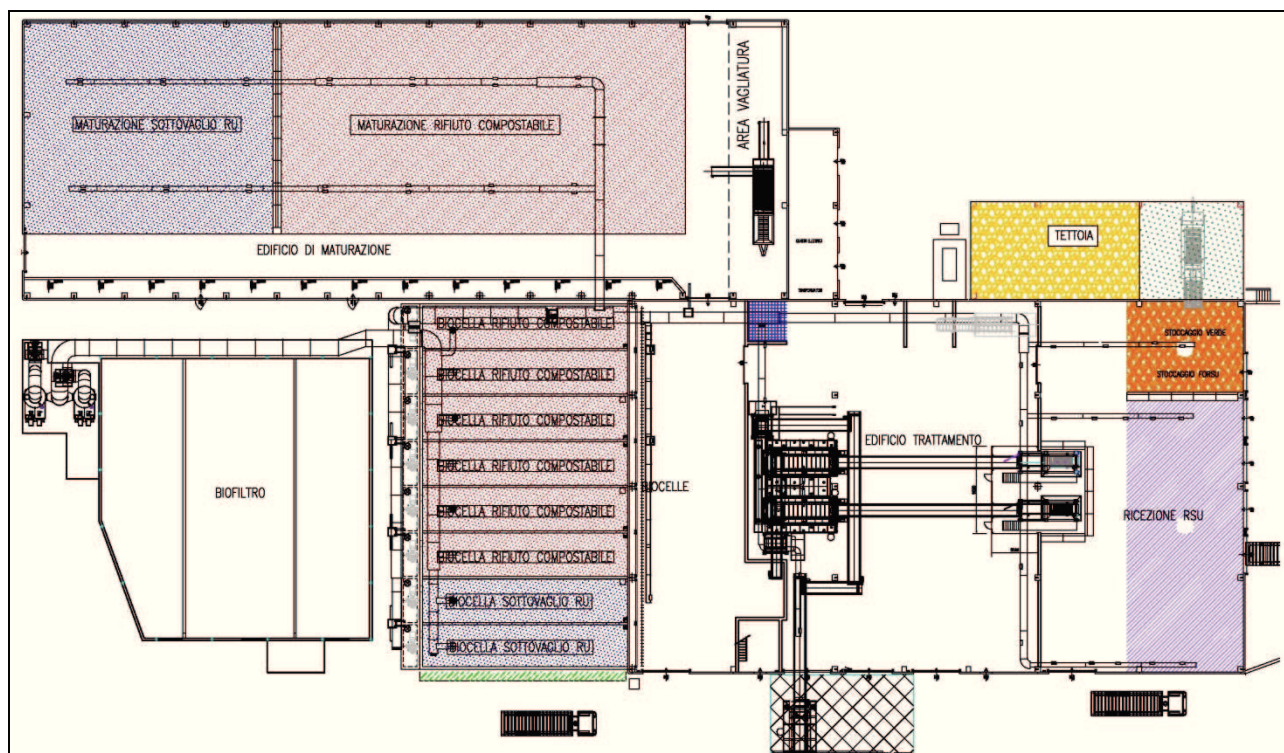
Stralcio della planimetria impiantistica attuale con la suddivisione delle aree di lavorazione.
